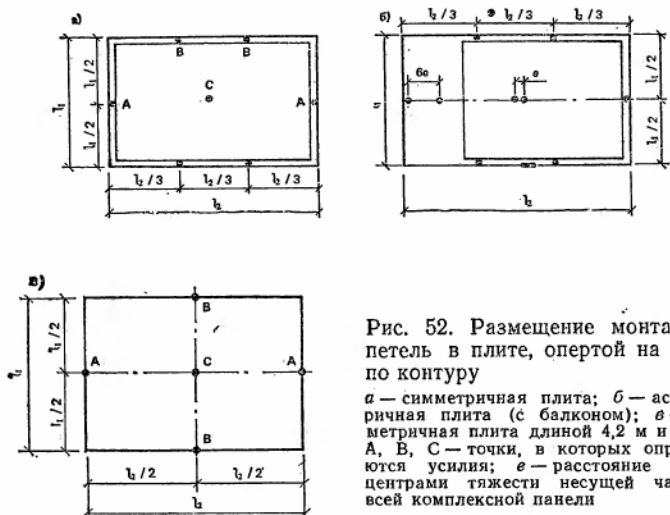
Размещение монтажных петель в плите, опертой на стены по контуру
